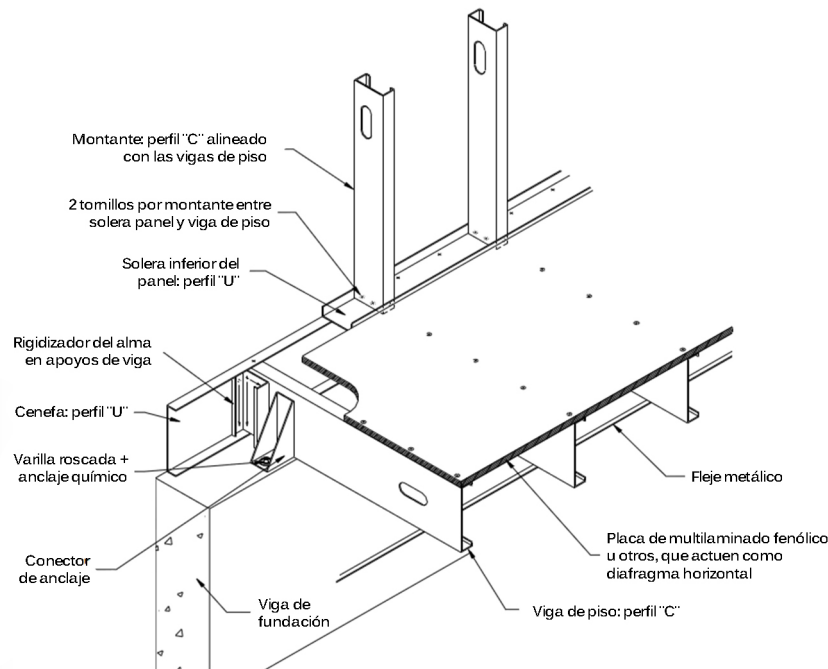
Detalle de la estructura elevada del nivel del terreno.
